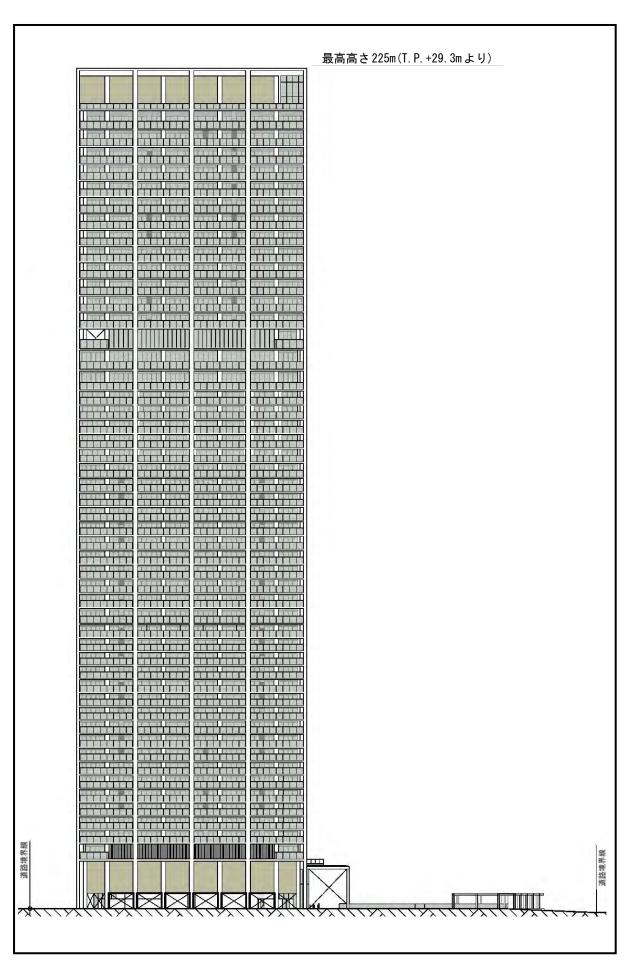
(4) 立面図 (西立面図 S=1:1,000)
